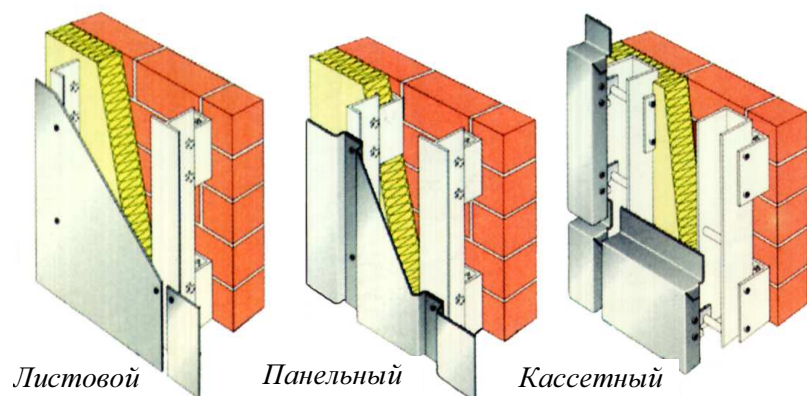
Основные варианты монтажа металлических фасадных облицовок.
